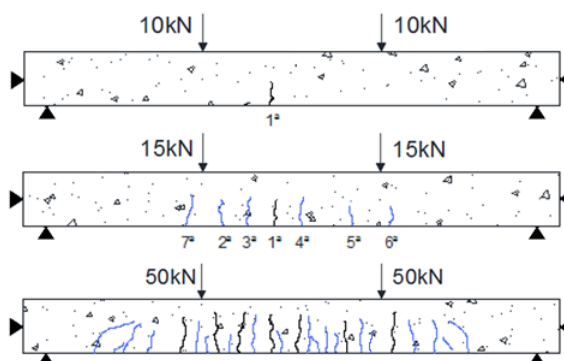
Formação e evolução das fissuras da Viga2.
